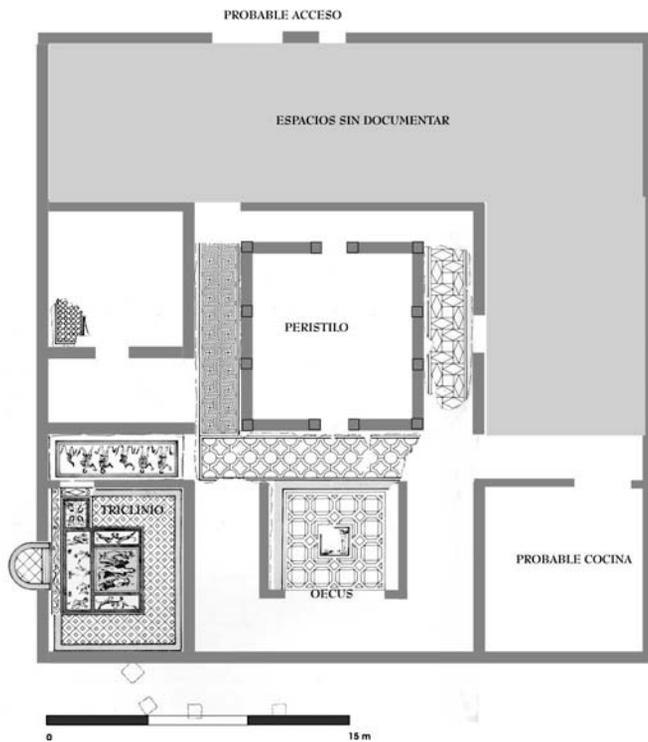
La Casa de Baco: Hipótesis con la reconstrucción de la planta.
